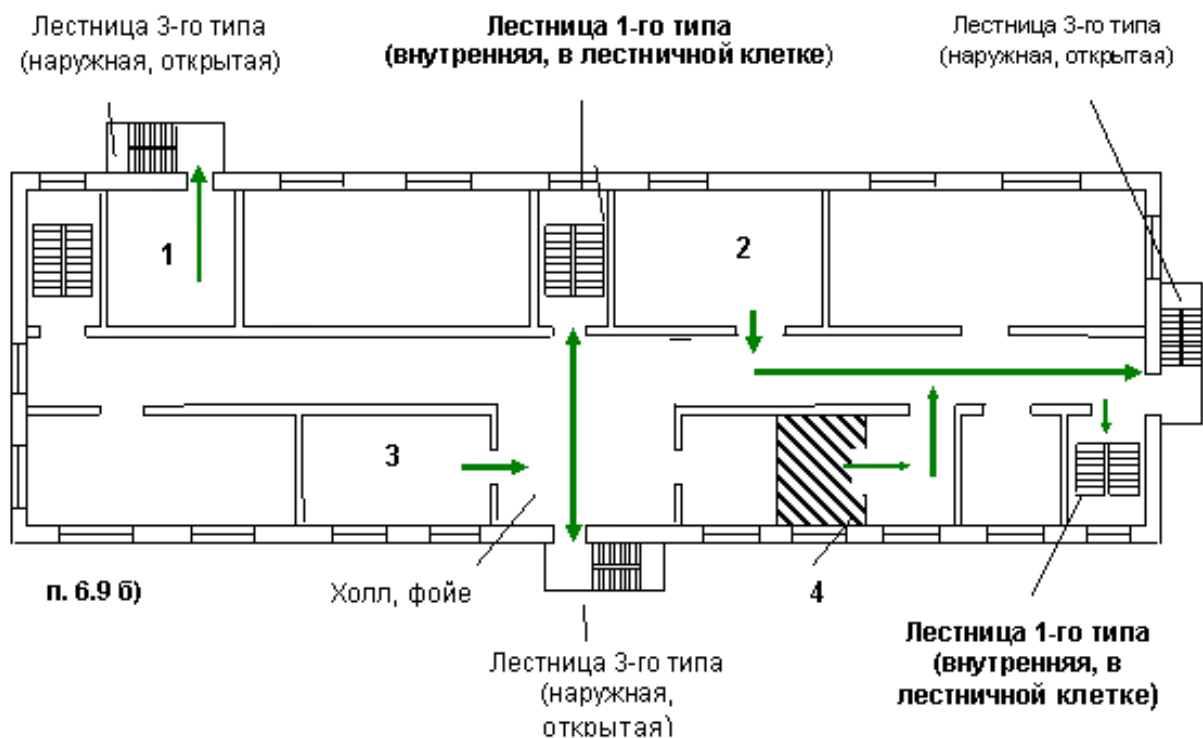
Эвакуационные выходы из помещений, расположенных на любых этажах, кроме 1-го.
